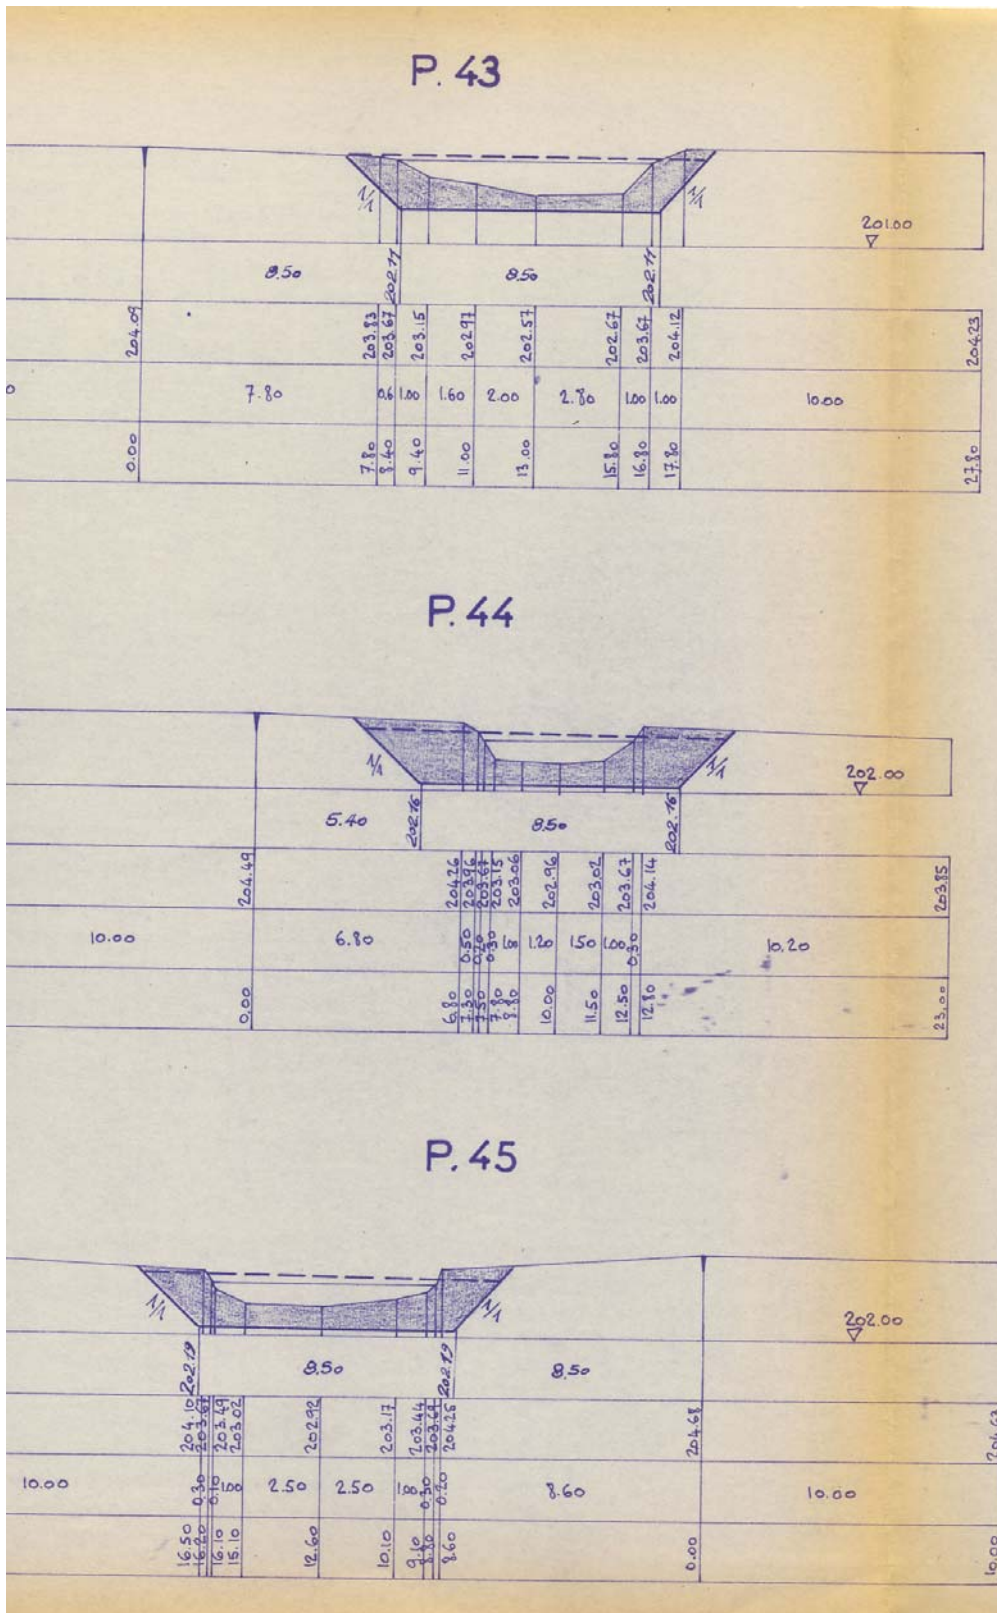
exemple de profils en travers réalisés avant les travaux.
